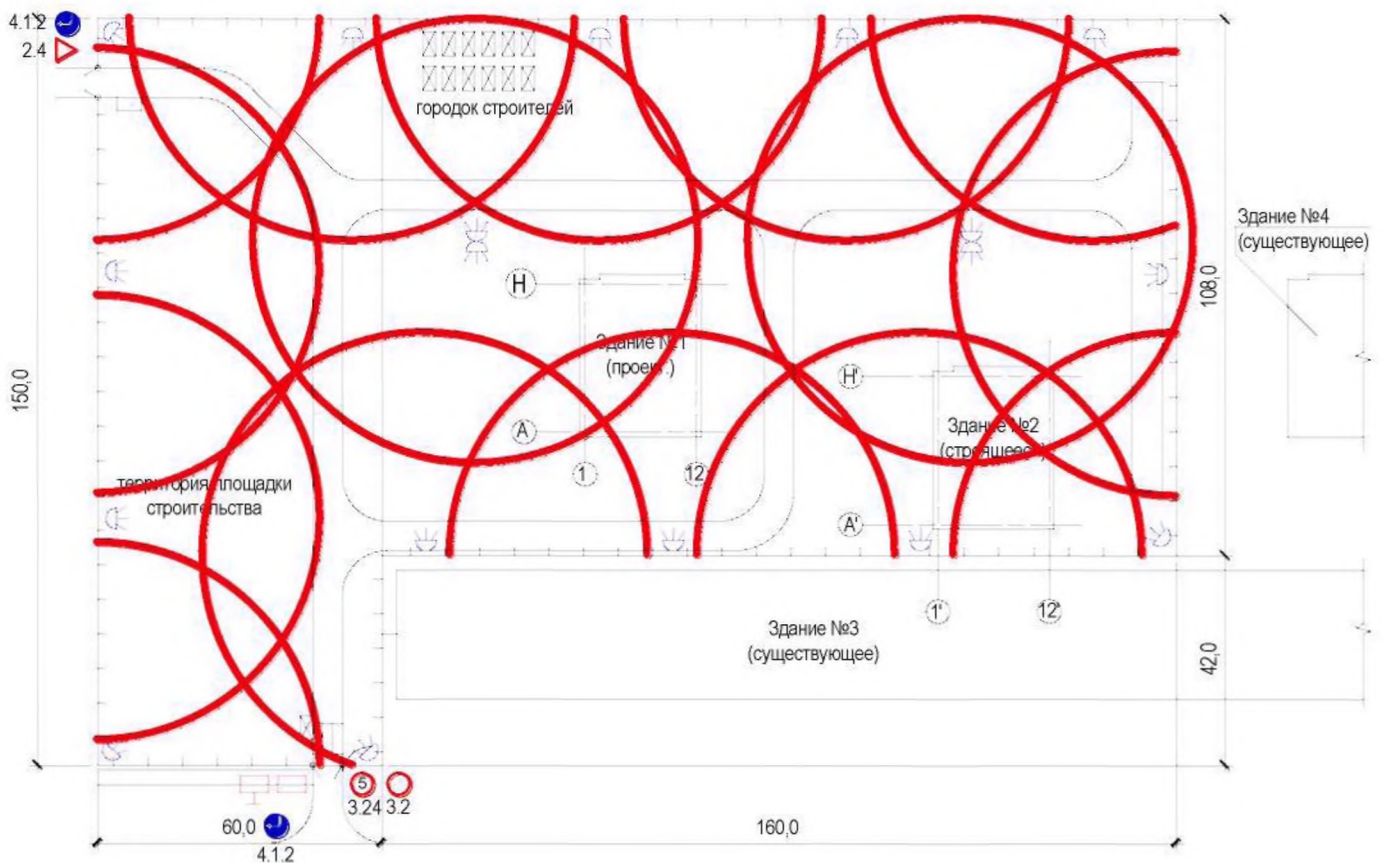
Размещение осветительных мачт на территории строительной площадки.
